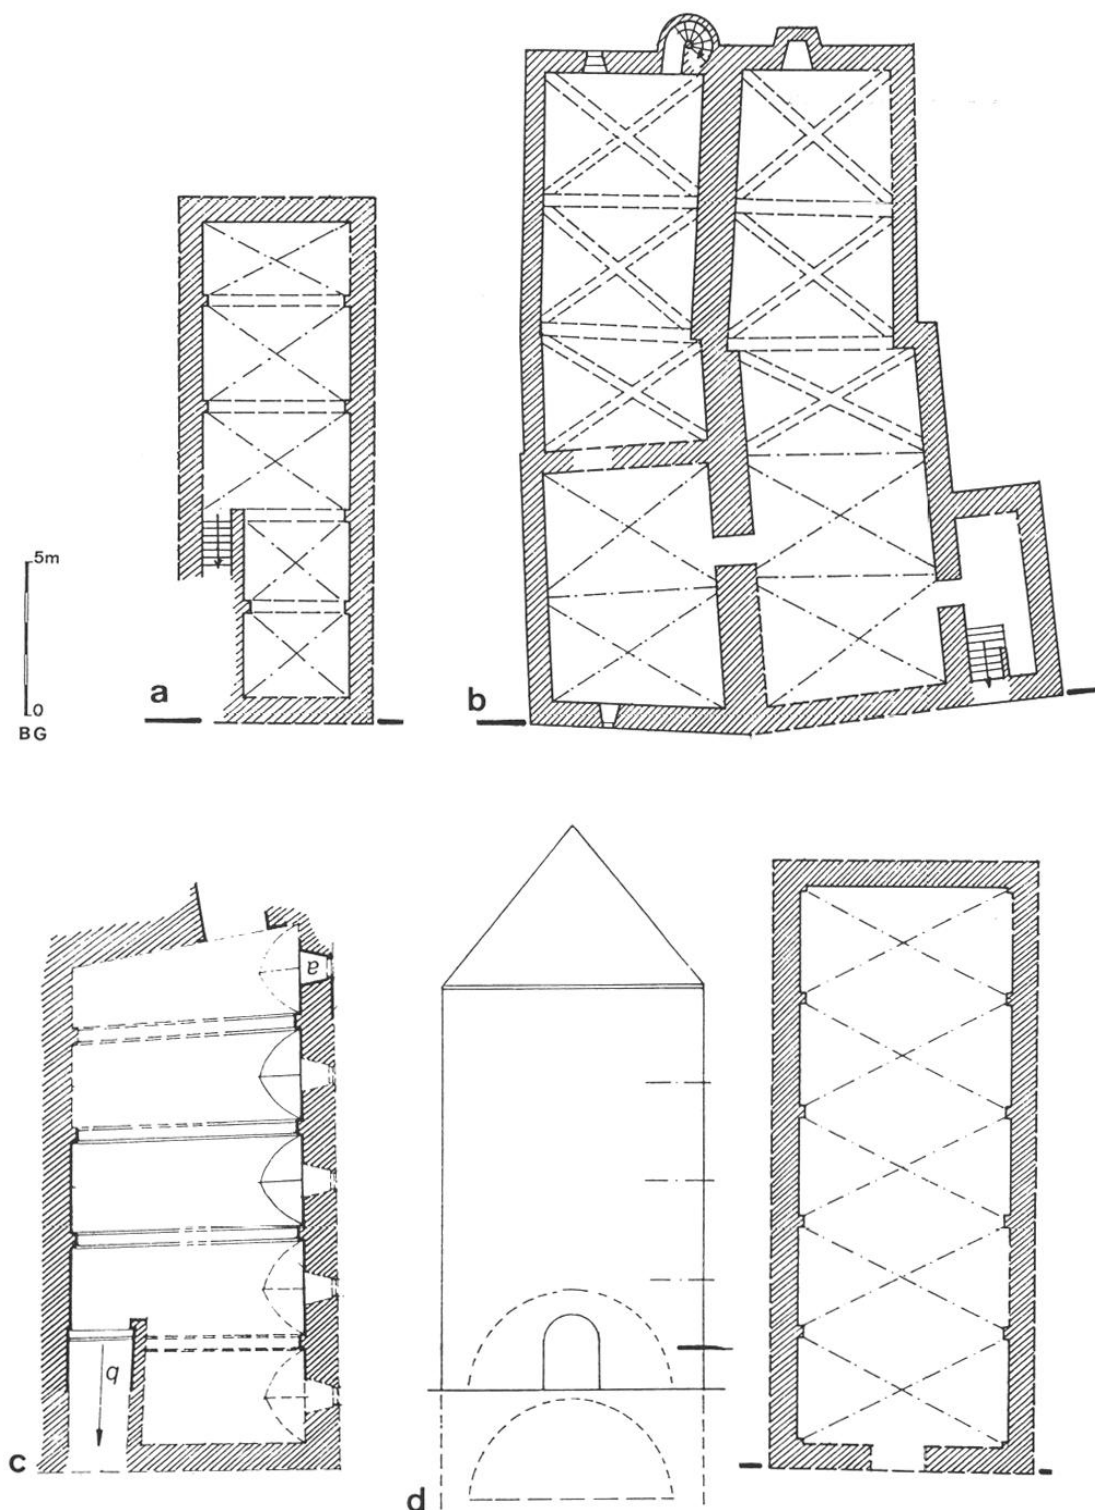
Maisons en pierre à Rouen, maisons de ville.
